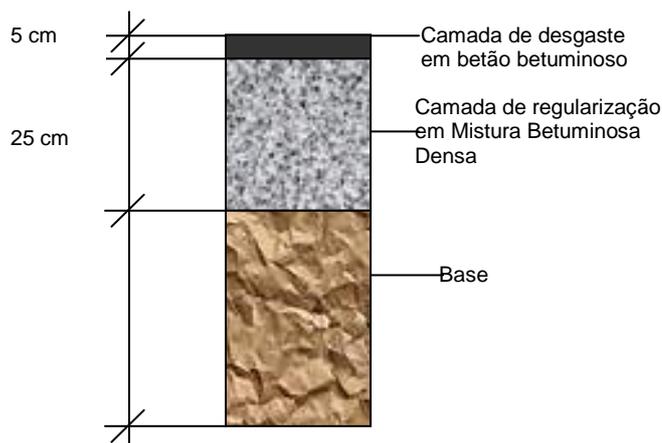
Estrutura inicial do pavimento (EN 222 – Barragem de Crestuma/Lever)
